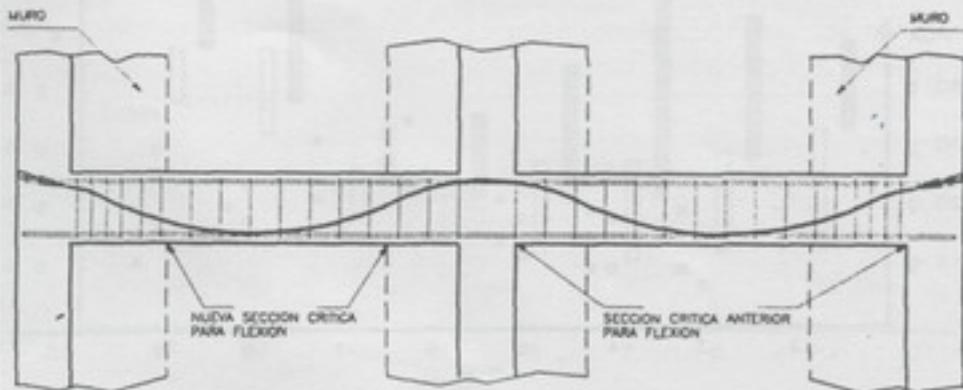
MODIFICACIÓN DE COMPORTAMIENTO DE VIGAS DE LOS EJES 3 Y 9
